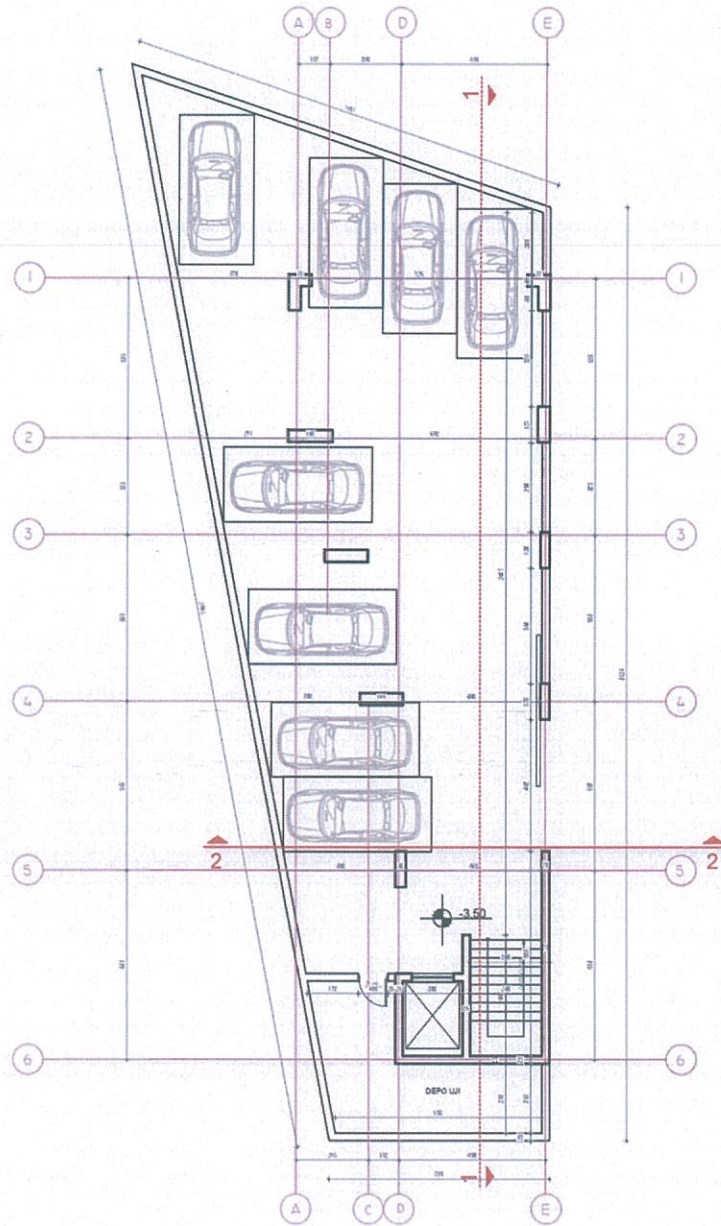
Planimetri e katit parkim (kuota -3.50)
